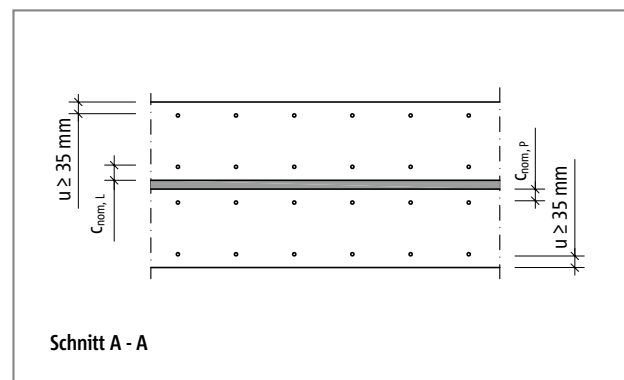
Schöck Tronsole® Typ BZ: Vertikalschnitt quer zur Treppe im Bereich des Konsolauflagers; Darstellung der Betondeckung $c_{nom,L}$, $c_{nom,P}$ und des Mindestachsabstandes u der Armierung
